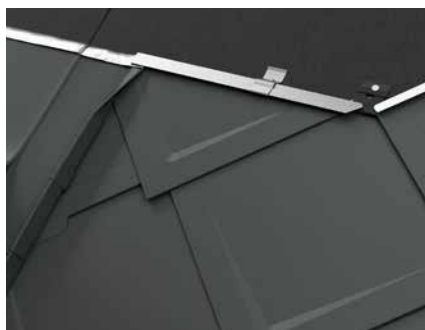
• Abergement de fenêtre de toit – Particularité pour les losanges de toiture 29 × 29 et 44 × 44
